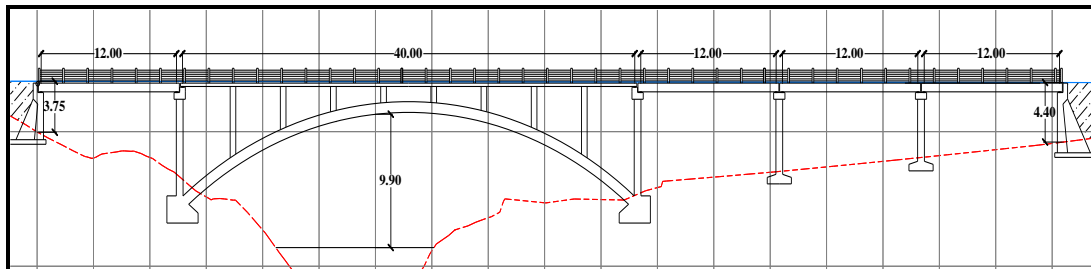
Perfil longitudinal de la alternativa 2, donde se muestran alturas de terraplén y la longitud pretendida del puente. (Fuente: Elaboración propia)
